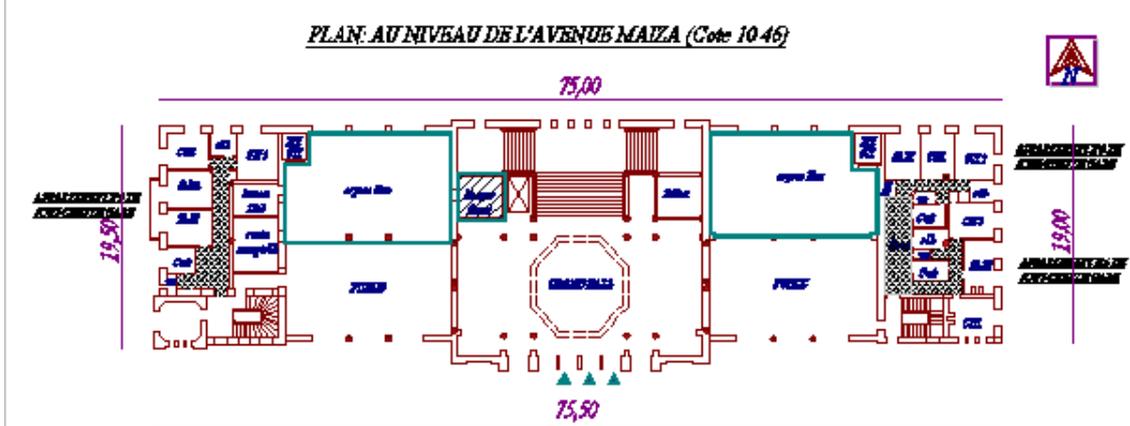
Le plan actuel du RDC (niveau de l'avenue MAIZA).
